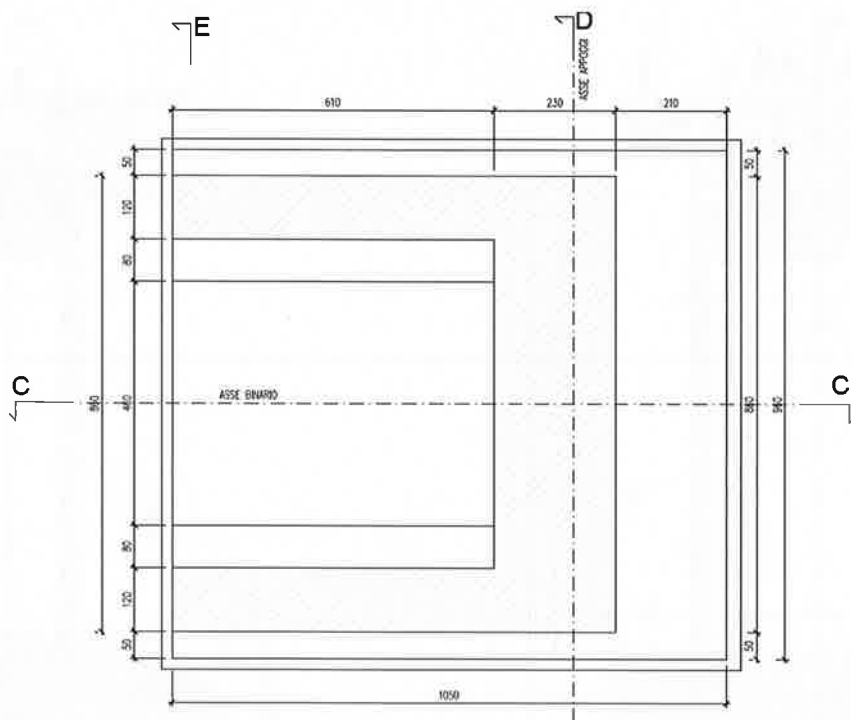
Pianta fondazione spalla A Bauladu VI02
